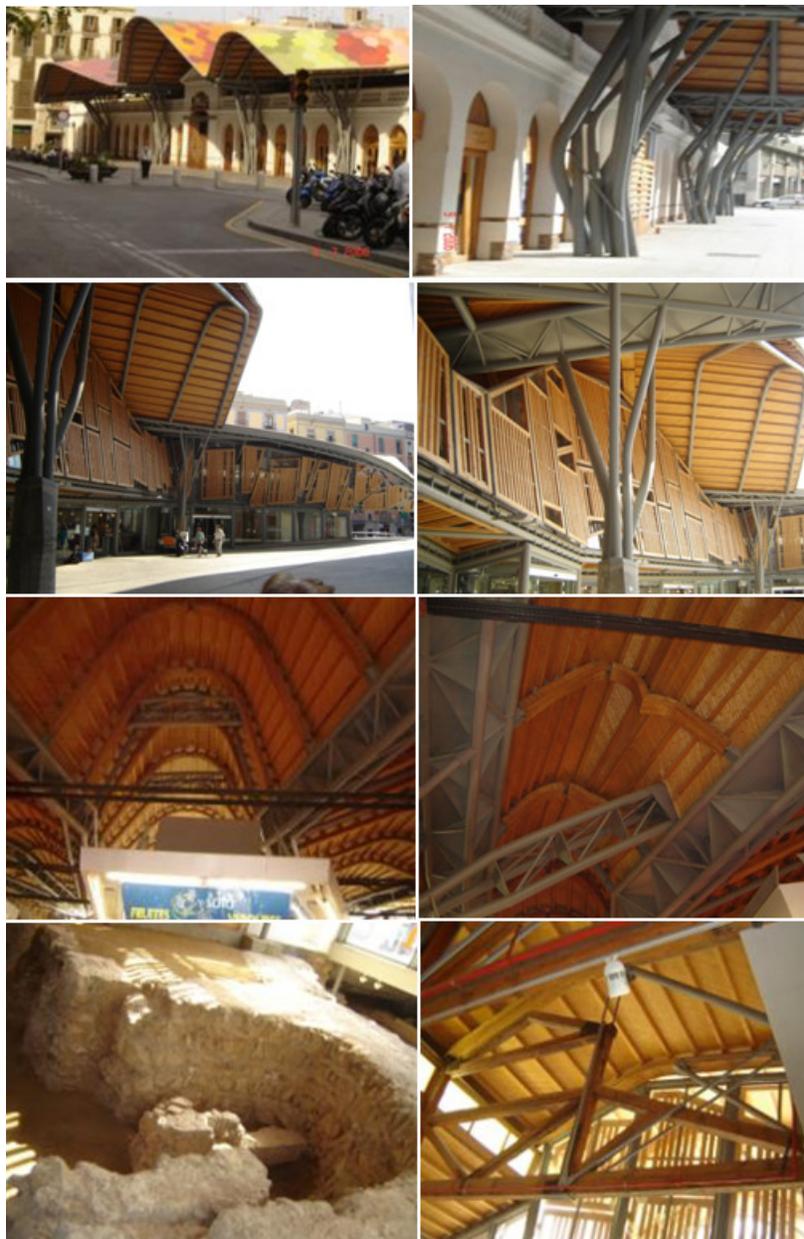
Mercado Santa Caterina em Barcelona; A) Cobertura da entrada na Av. Cambó; B) Pilares na Av. Cambó; C) Praça Joan Capri; D) Detalhe do pilar e brise da Praça Joan Capri; E) Estruturas na parte interna; F) Detalhe do grande arco treliçado; G) Ruínas do mosteiro; H) Estruturas de tesouras preservadas do antigo mercado. Fonte: autores, 2006
